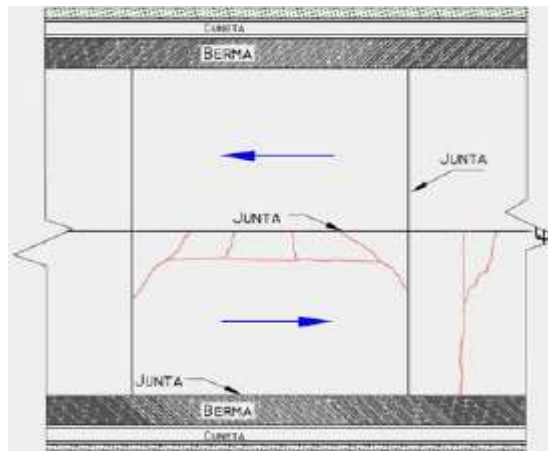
Vista en planta de grieta (GB) (INVIAS, 2006).
